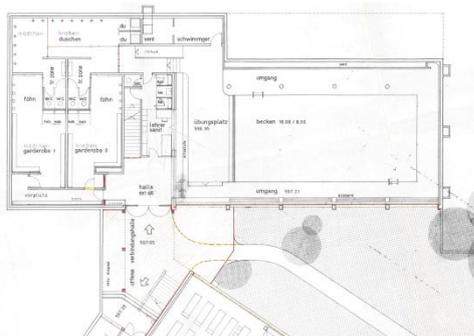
Grundriss Hallenbad mit Garderoben
